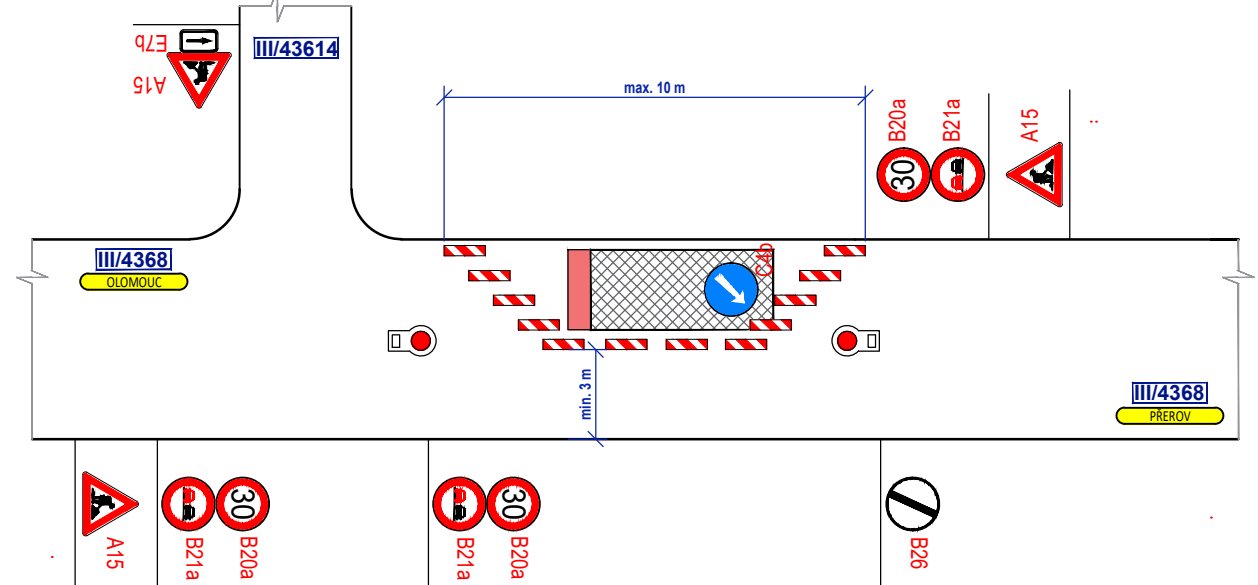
### DETAIL PRACOVNÍHO MÍSTA 1 - INTRAVILÁN
